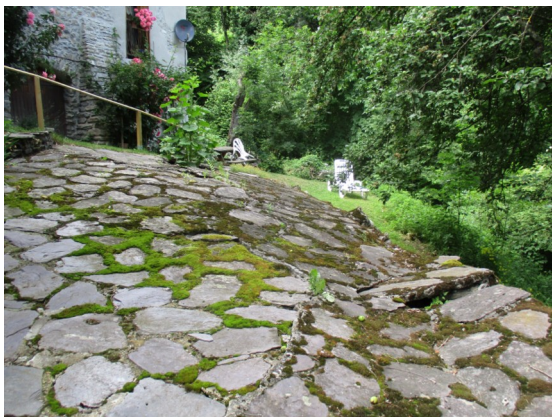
Terrasse disloquée témoignant d'une activité sur la zone
